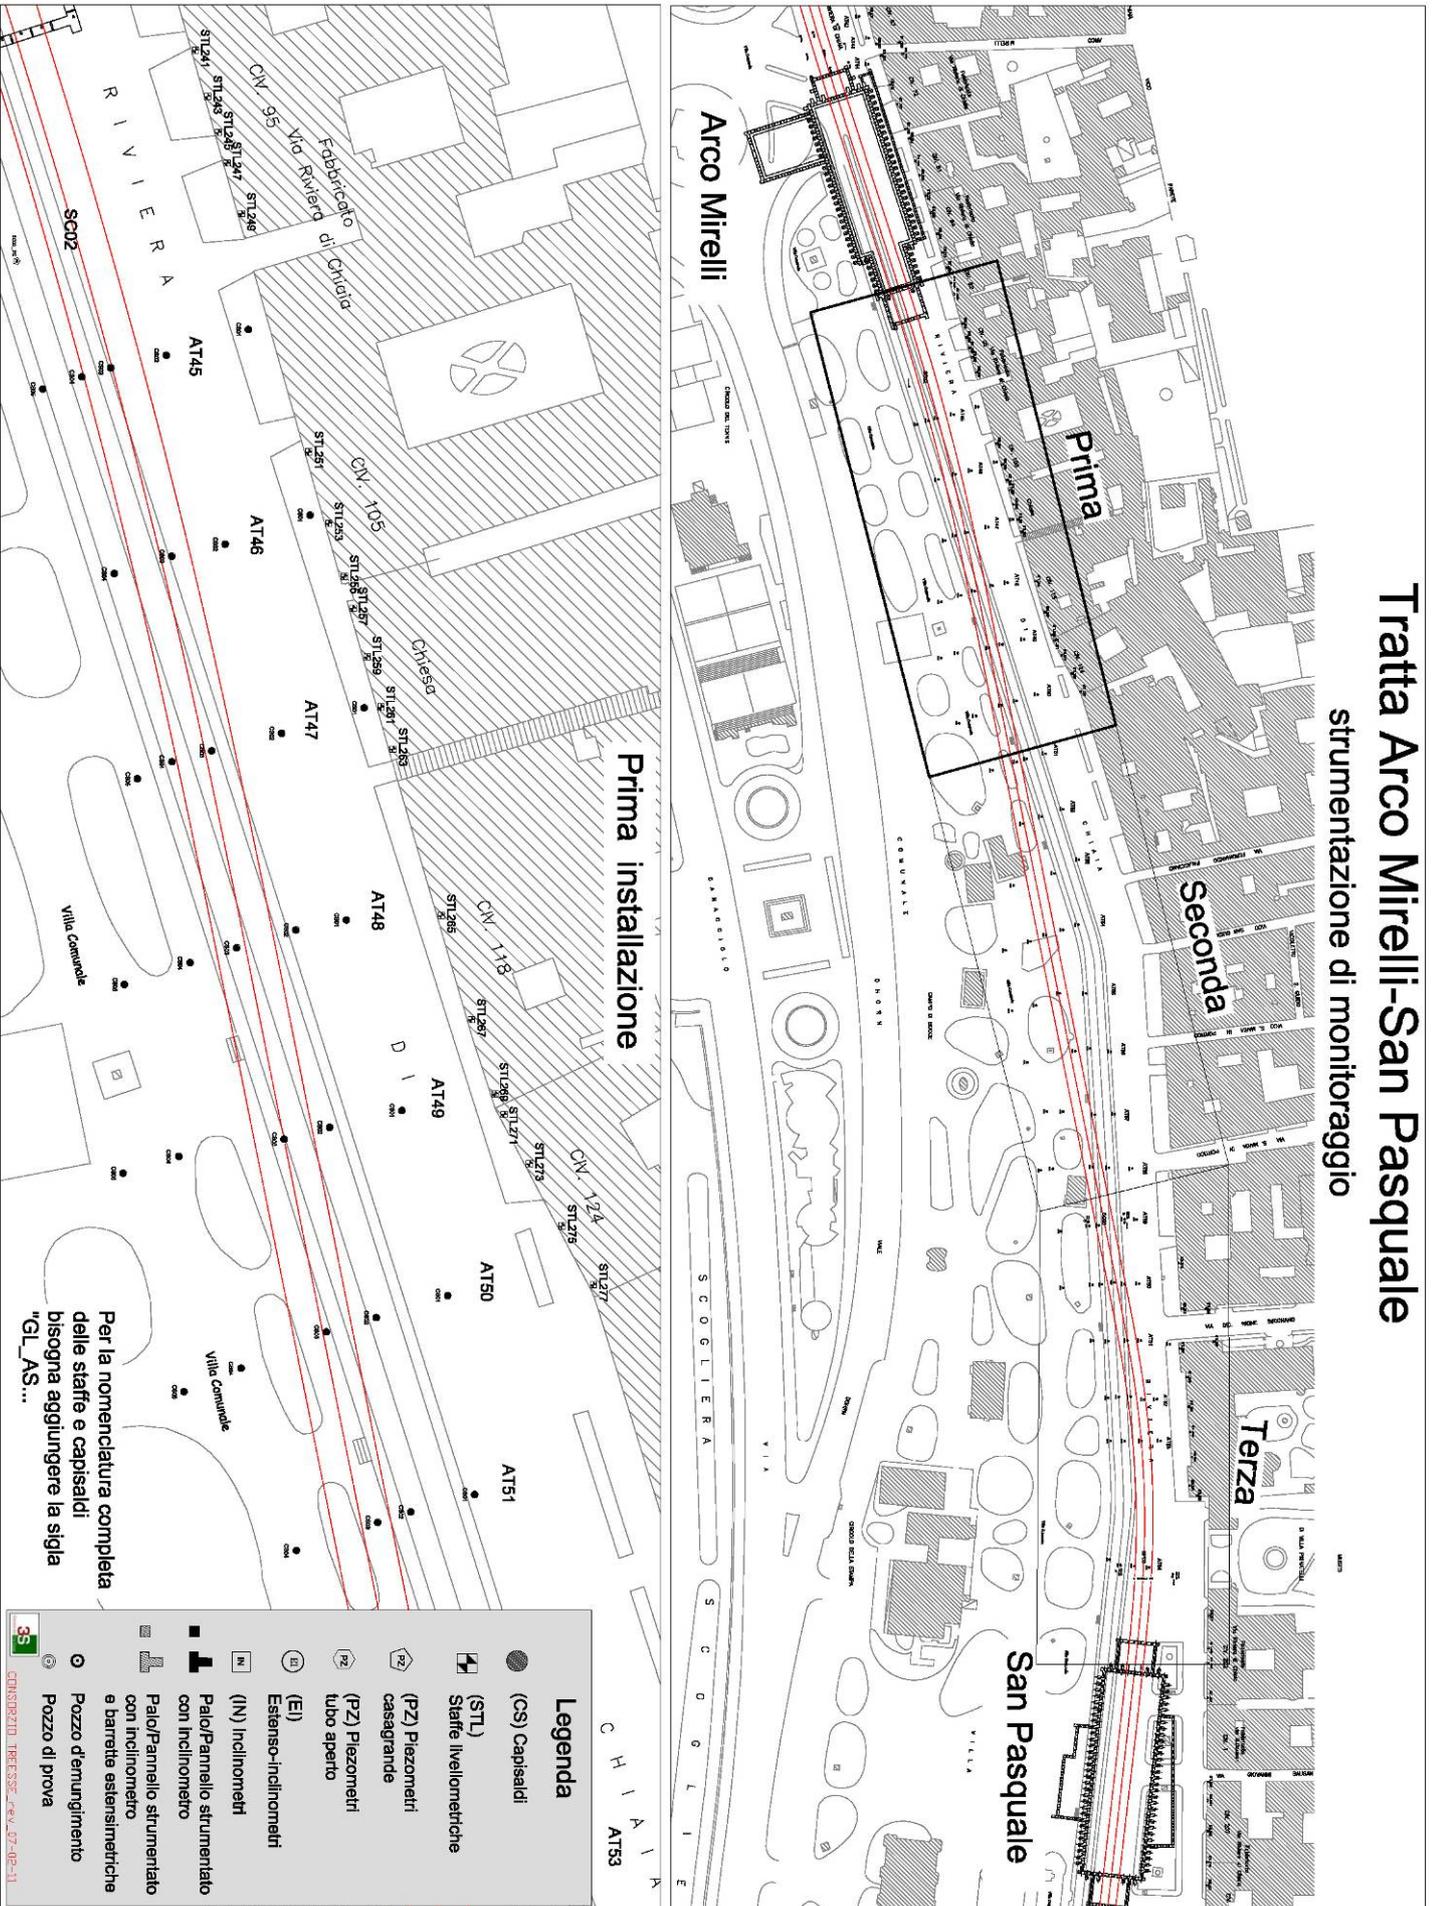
Planimetria tratta Arco Mirelli-San Pasquale, raffigurante la disposizione della prima installazione della strumentazione di monitoraggio.
